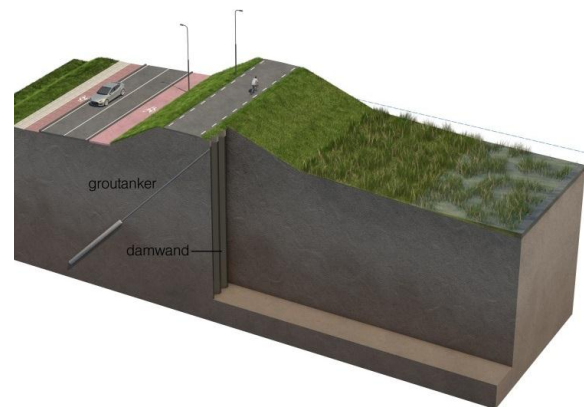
Alternatief 1: Damwand buitenkruinlijn met wegverhoging
